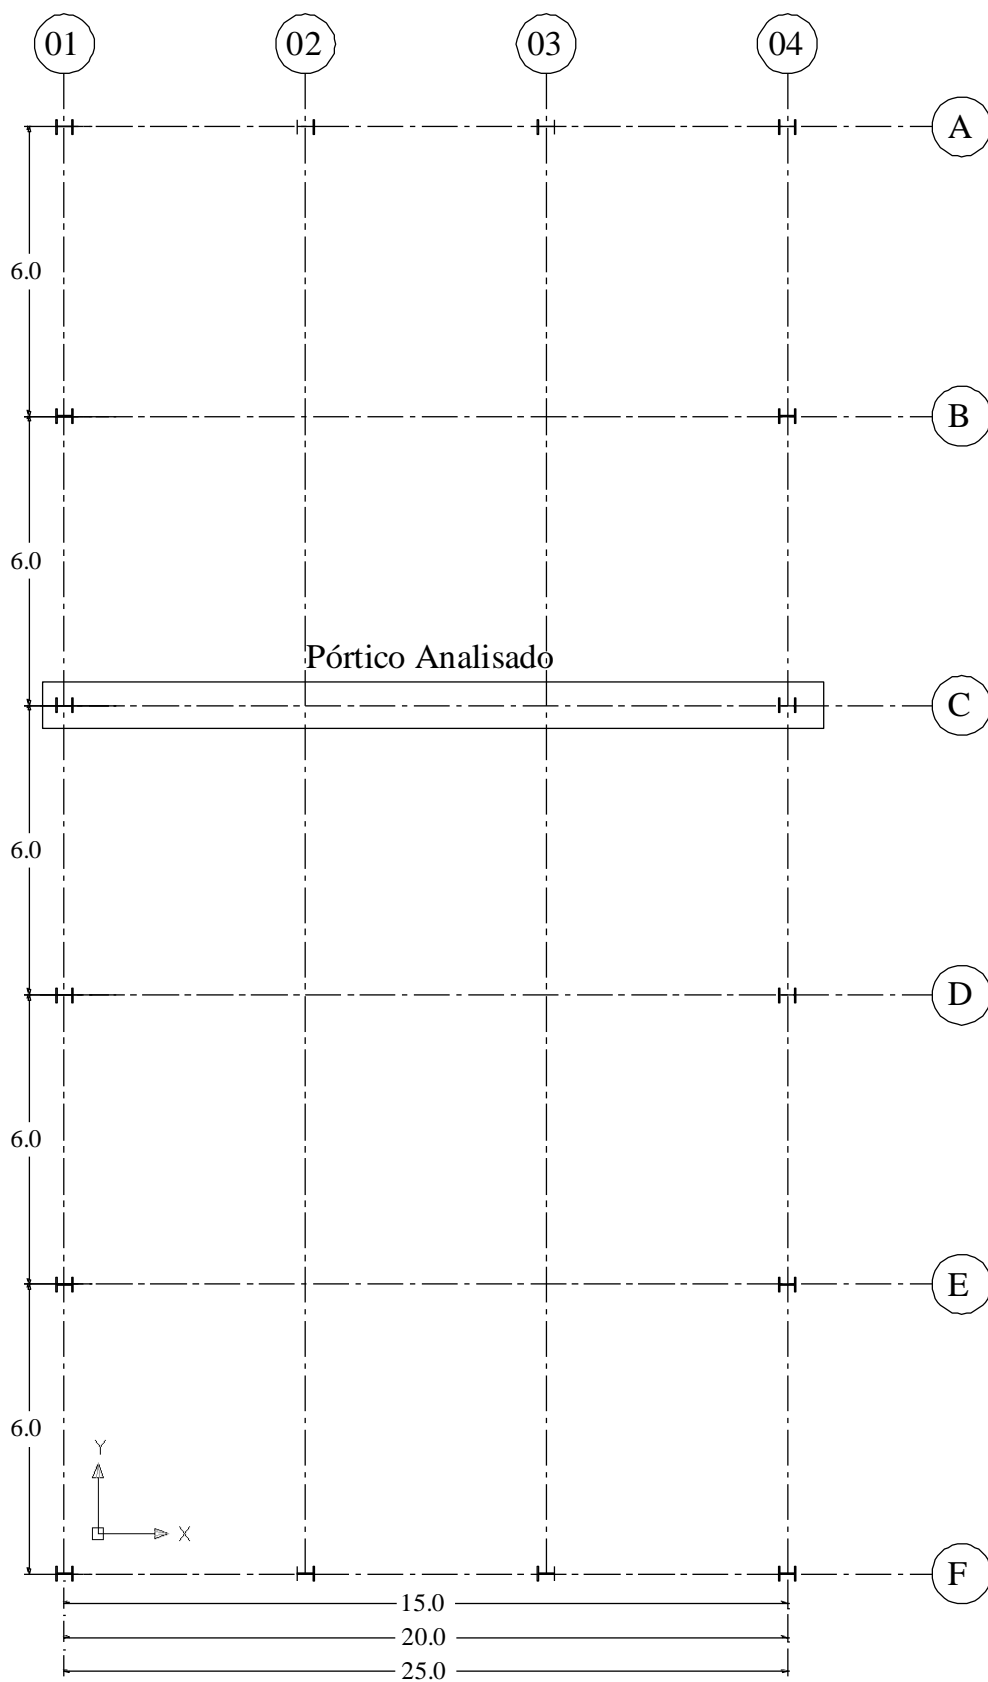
Planta de localização dos pórticos metálicos de travessas inclinadas (dimensões em metro).
